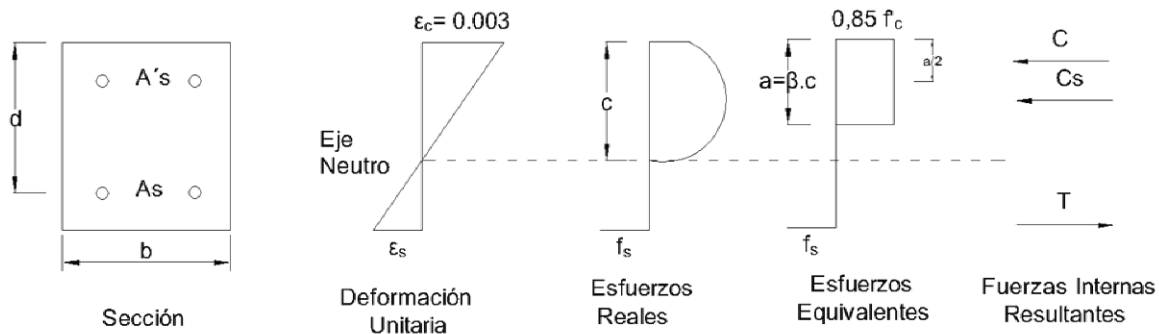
Sección de concreto doblemente reforzada cuando se alcanza la resistencia a Flexión. Fuente: Estructuras de Concreto Reforzado. R. Park/T. Paulay
